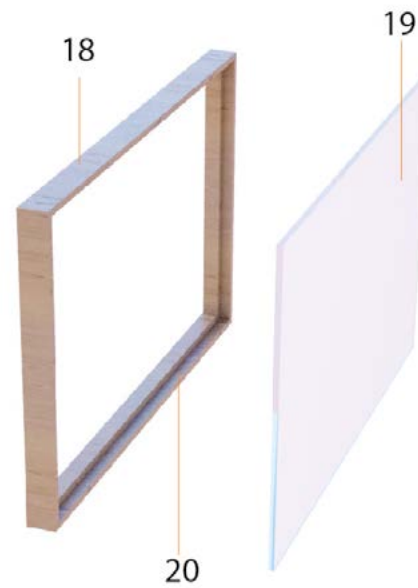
Detalle constructivo 3d puerta con madera de pino
